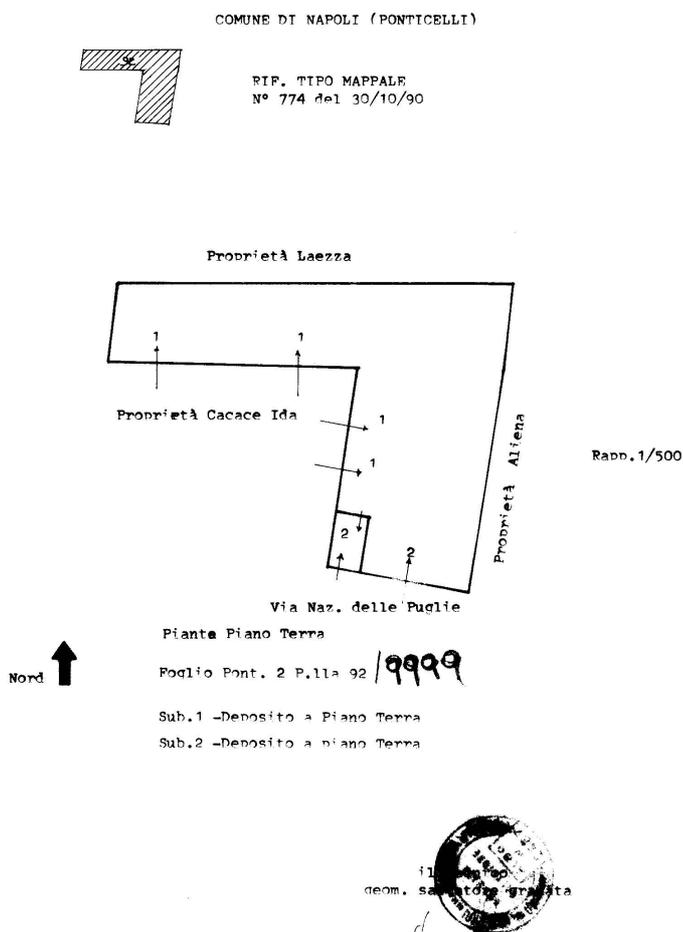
Elaborato planimetrico rinvenuto agli atti del catasto
